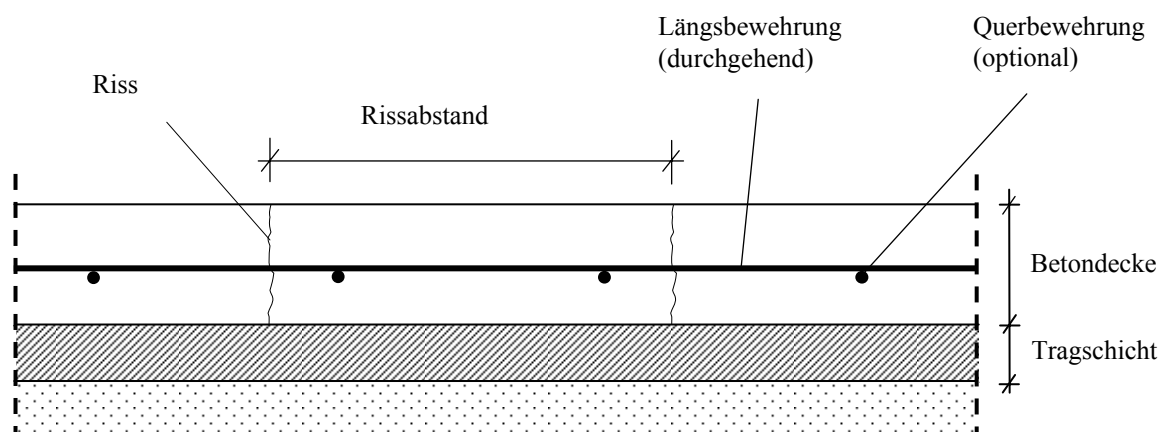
Prinzipskizze einer durchgehend bewehrten Betondecke
